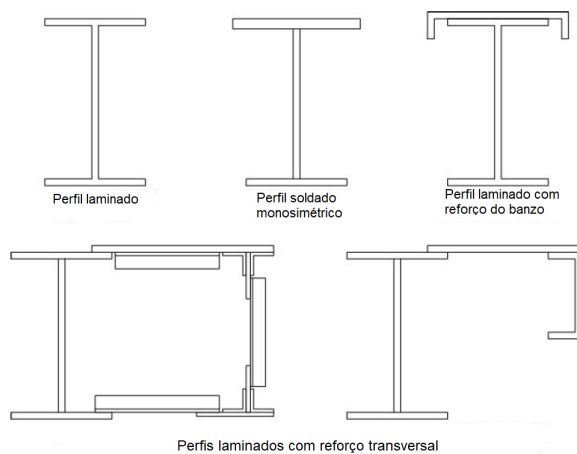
Exemplos de secções transversais adotadas em vigas de caminho de rolamento, adaptado de [37].
